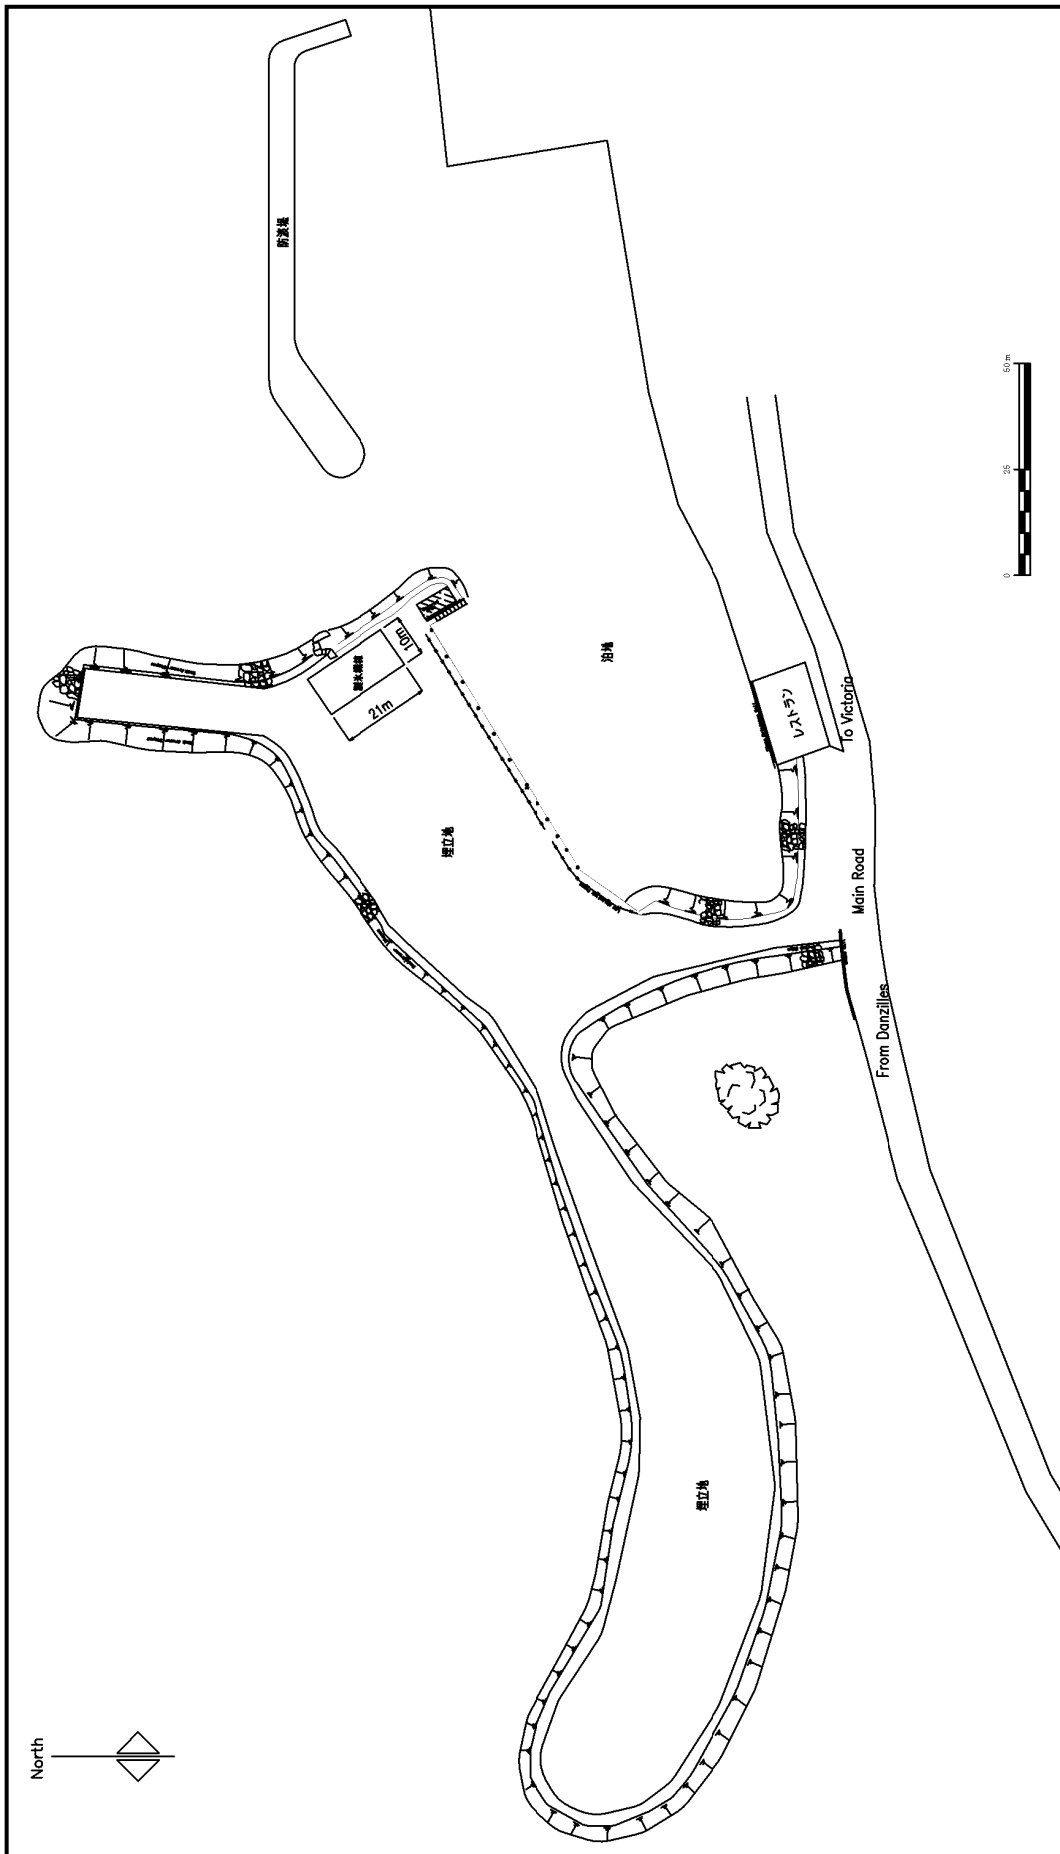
(6) 計画平面図 (ベル・オンブレ漁港)
